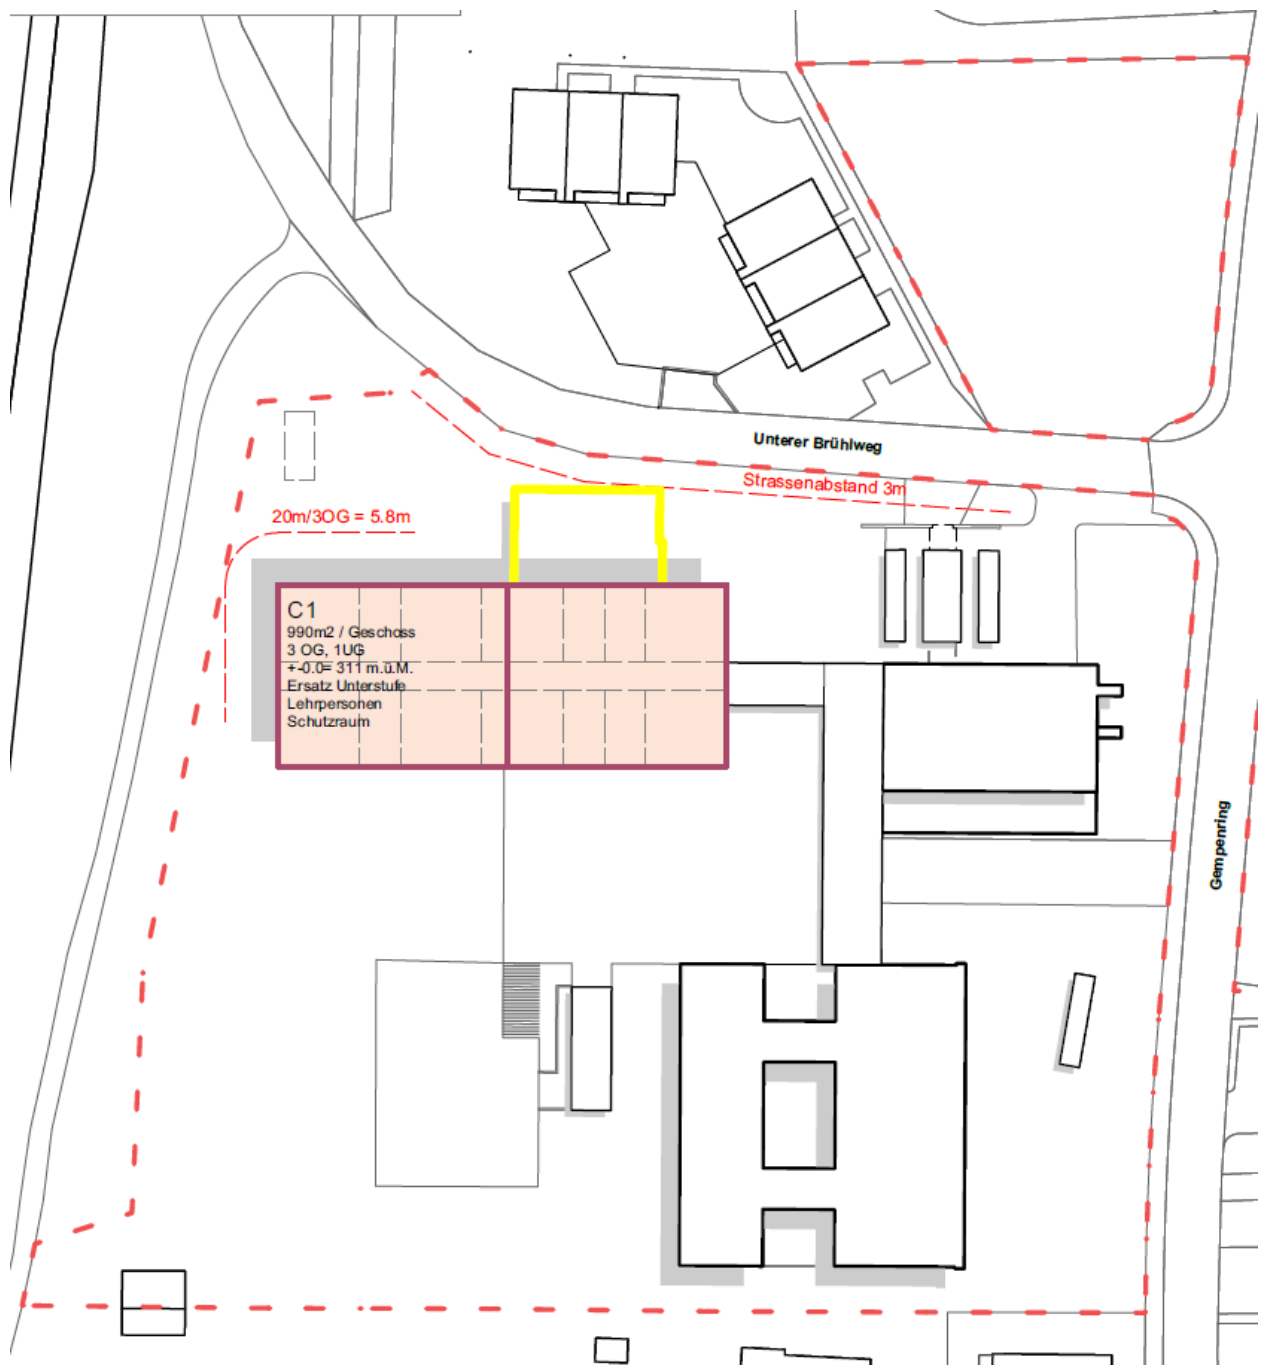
Etappe 2, Grundriss C.1
